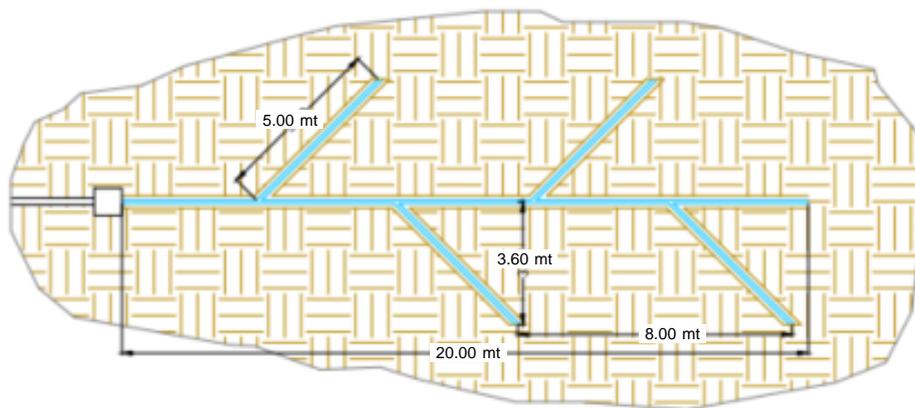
Particolare in pianta e sezione dell'impianto di dispersione
